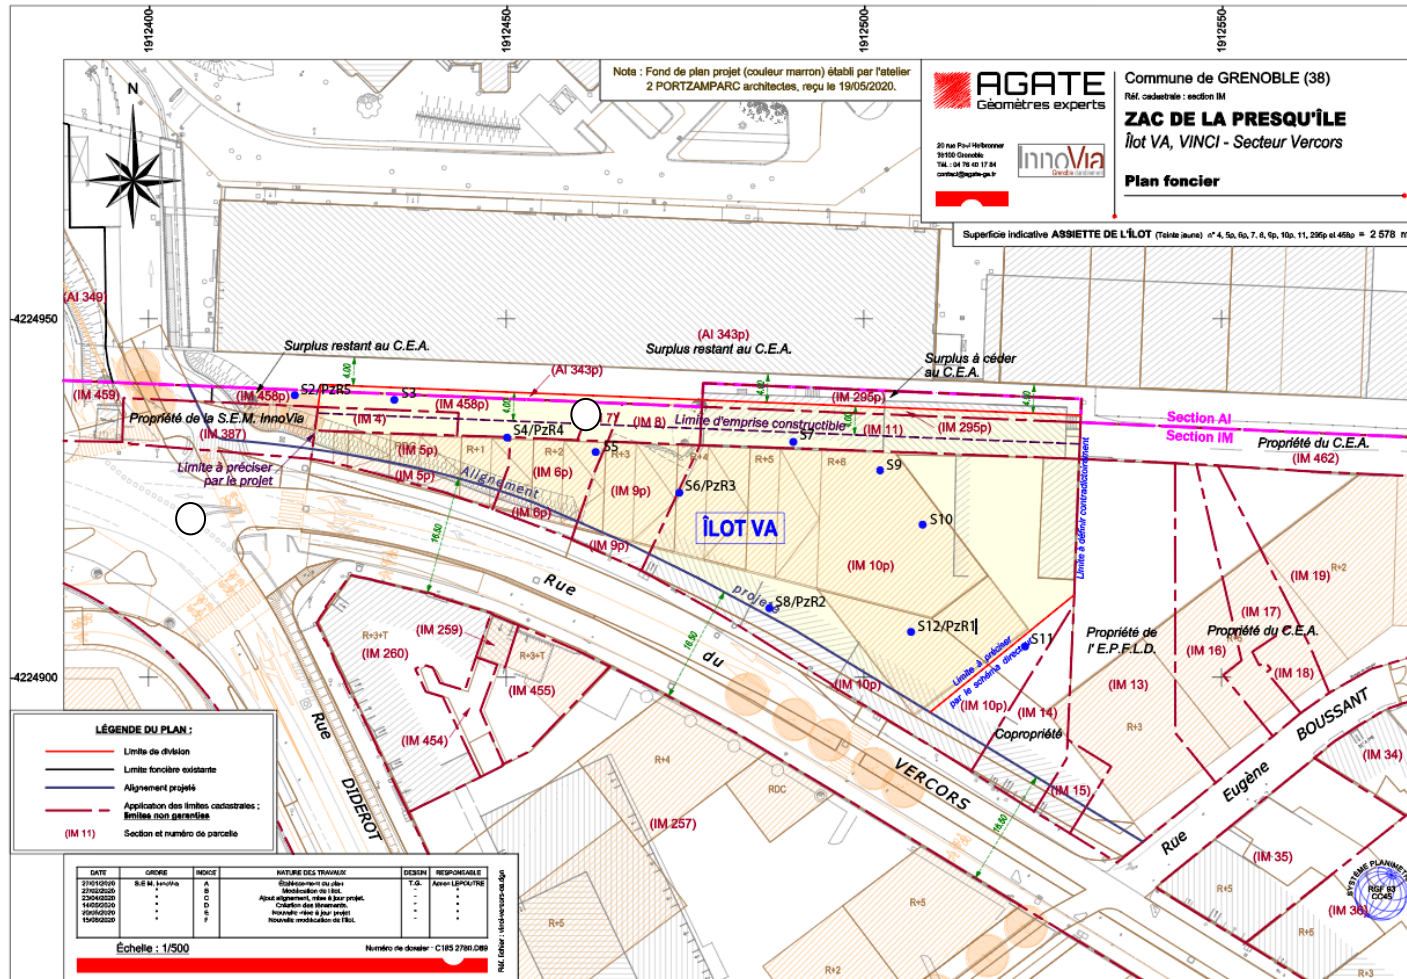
Plan d'implantation des sondages et ouvrages au droit du site
